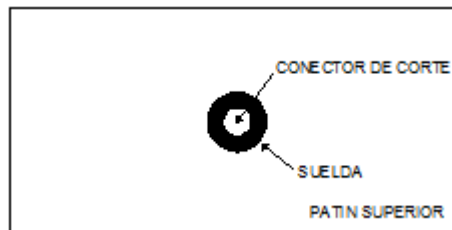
Ubicación del cordón de soldadura entre el conector de corte y el patín superior de viga (vista superior)
